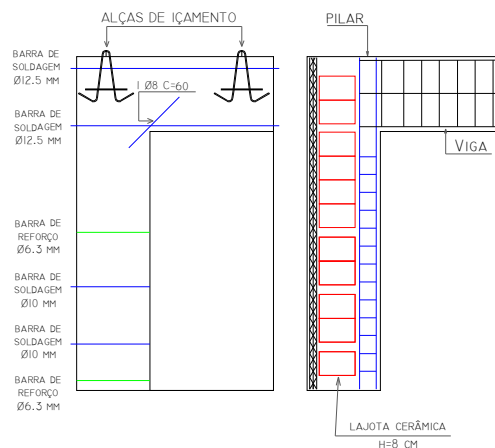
Planta com os elementos constituintes do painel com vão de porta edificações habitacionais de até 05 pavimentos
